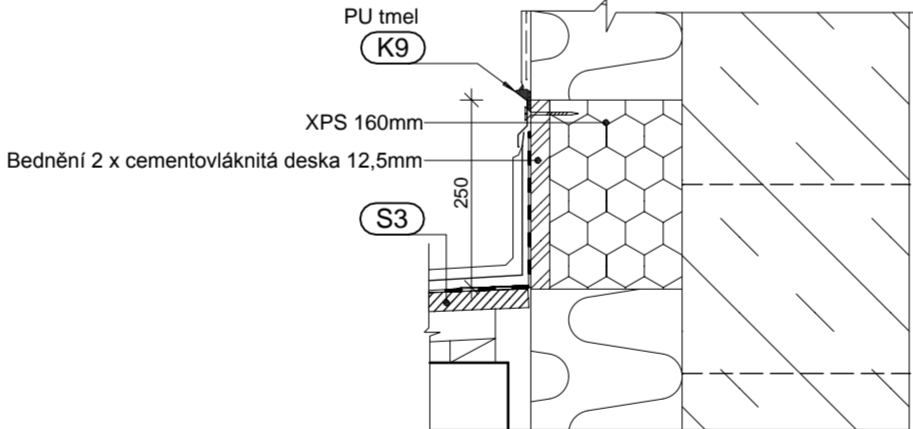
ukončení PVC fólie/stěna nástavby (1:10)
